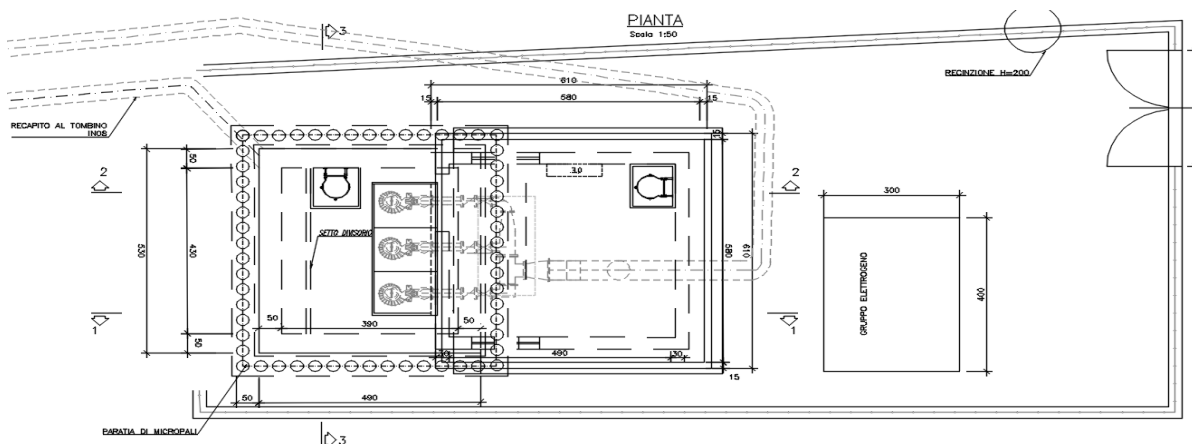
Impianto di sollevamento NV13 – Pianta
